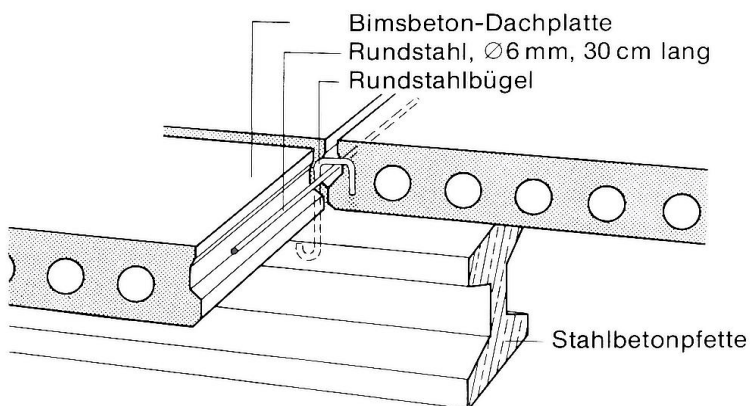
Beispiel für die Auflagerung aus Stahlbeton- und Spannbetonträgern (Neunast u. Theiner 1981)
